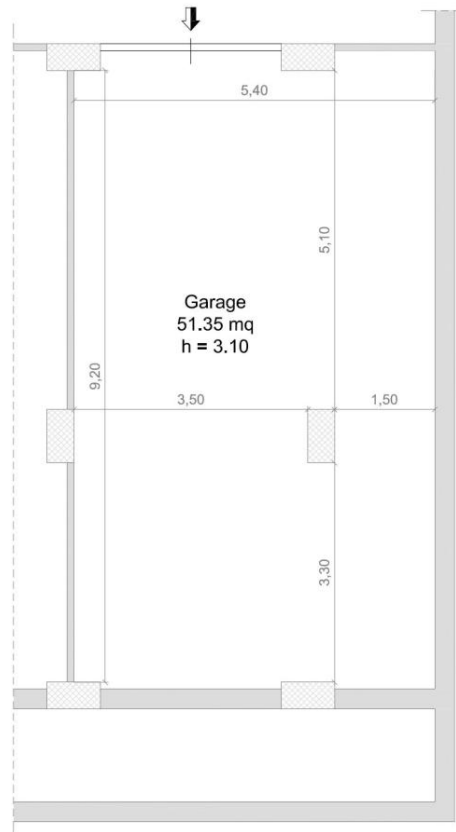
Planimetria Catastale Foglio 30, p.lla 2169, sub 27.
